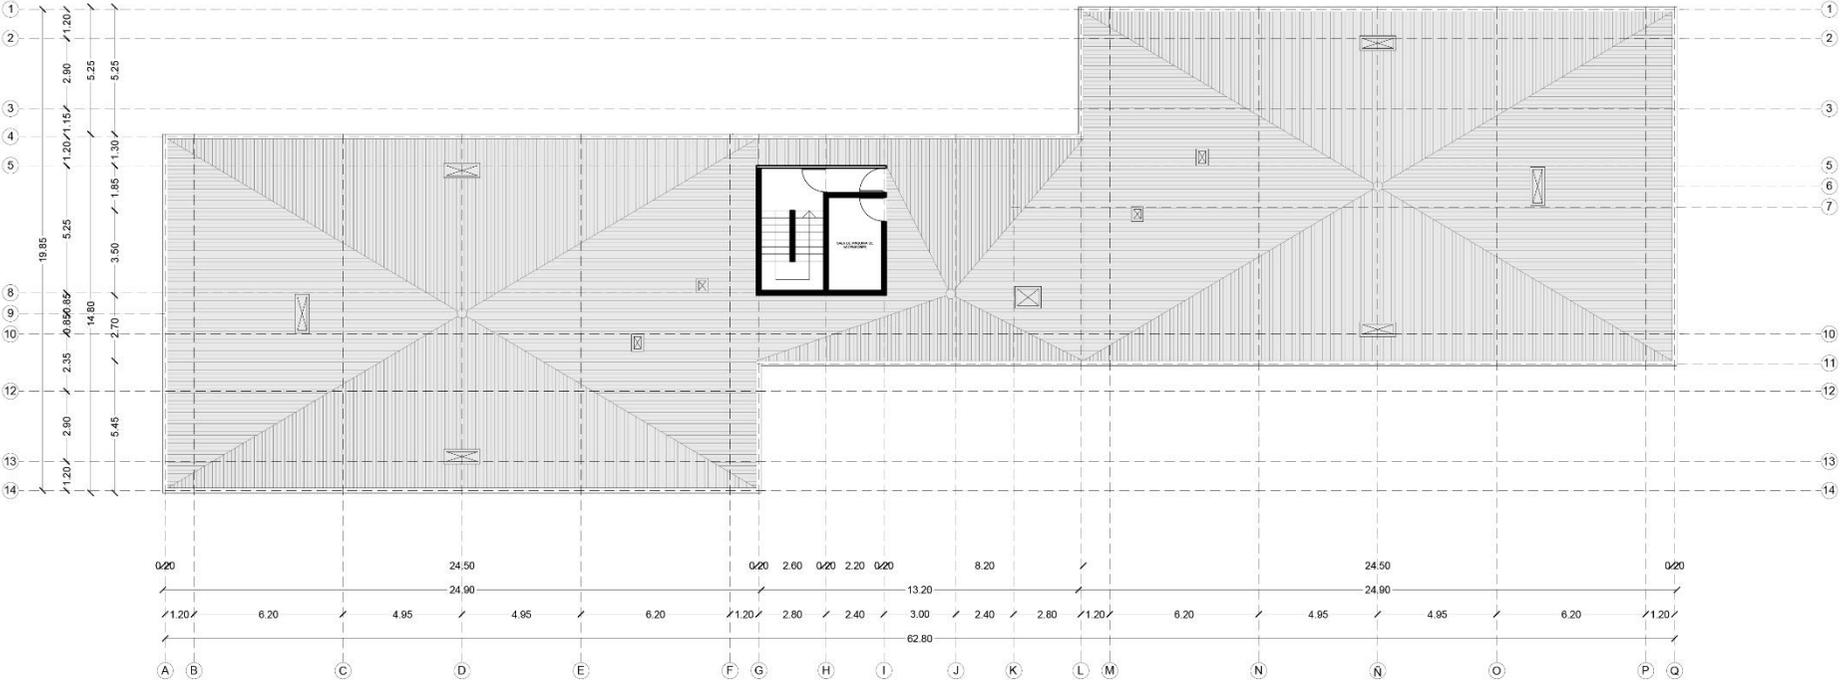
Planta de techo edificio 6 pisos, escala 1/200. Fuente: Elaboración propia.
